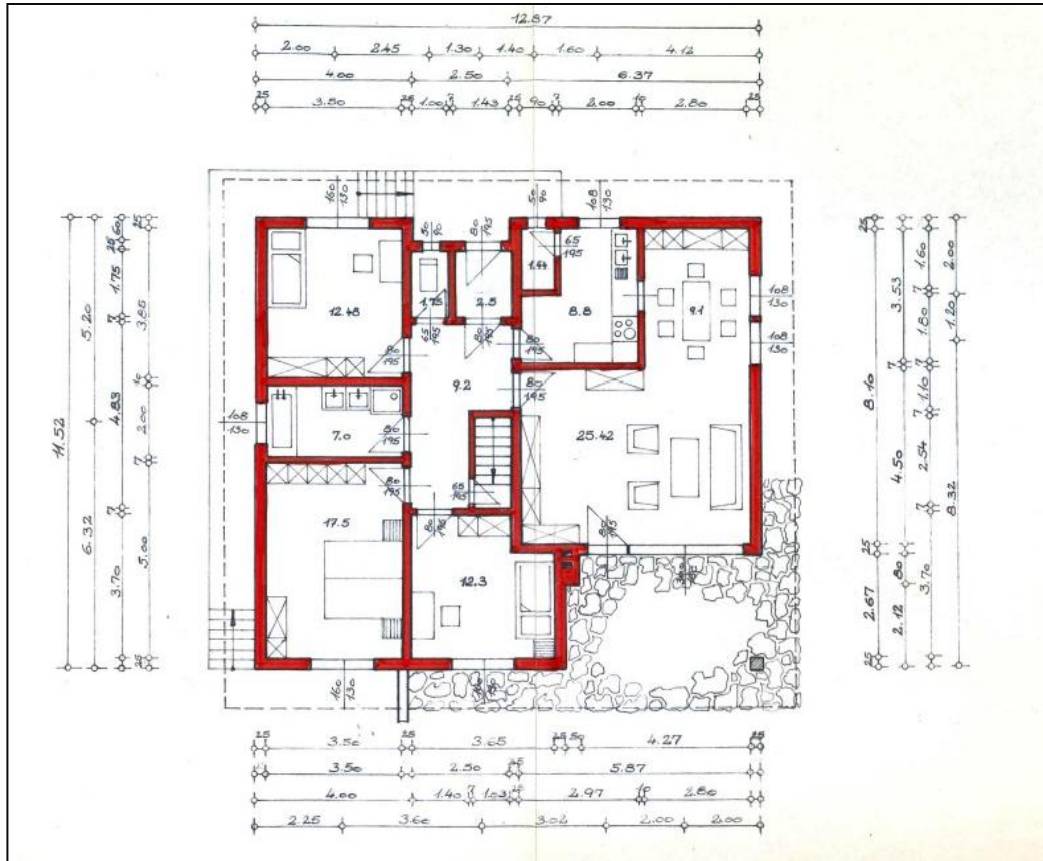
Grundrissplan OG des Bestandes aus dem Jahr 1989
